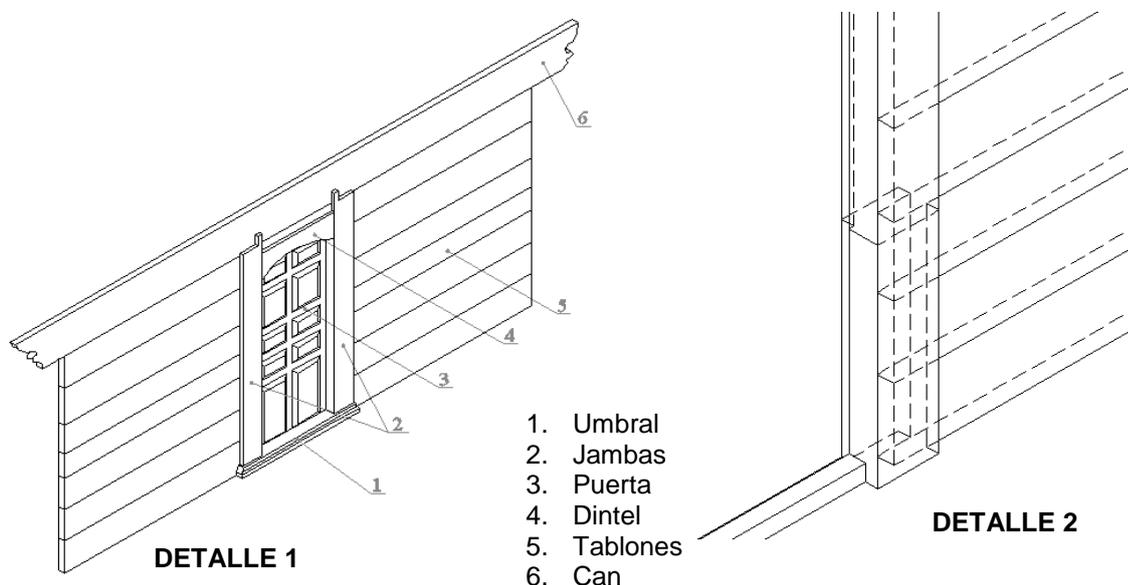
Detalle1. Elementos del acceso. Detalle 2. Tablones embutidos en la jamba. Caso: TP-3. Fuente: Elaboración propia.
